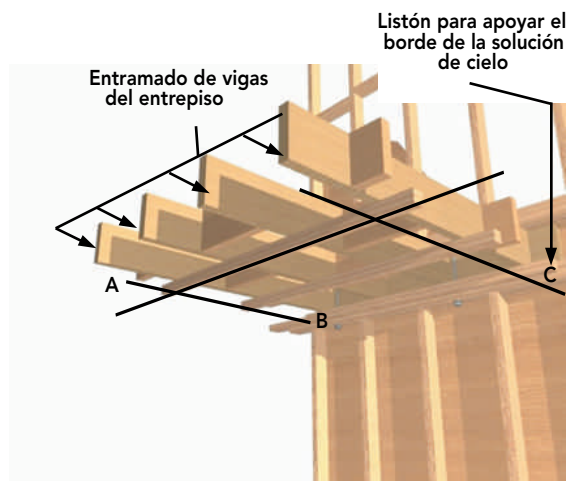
Las tres rectas (A, B y C) pertenecen al plano horizontal determinado por el listoneado.
